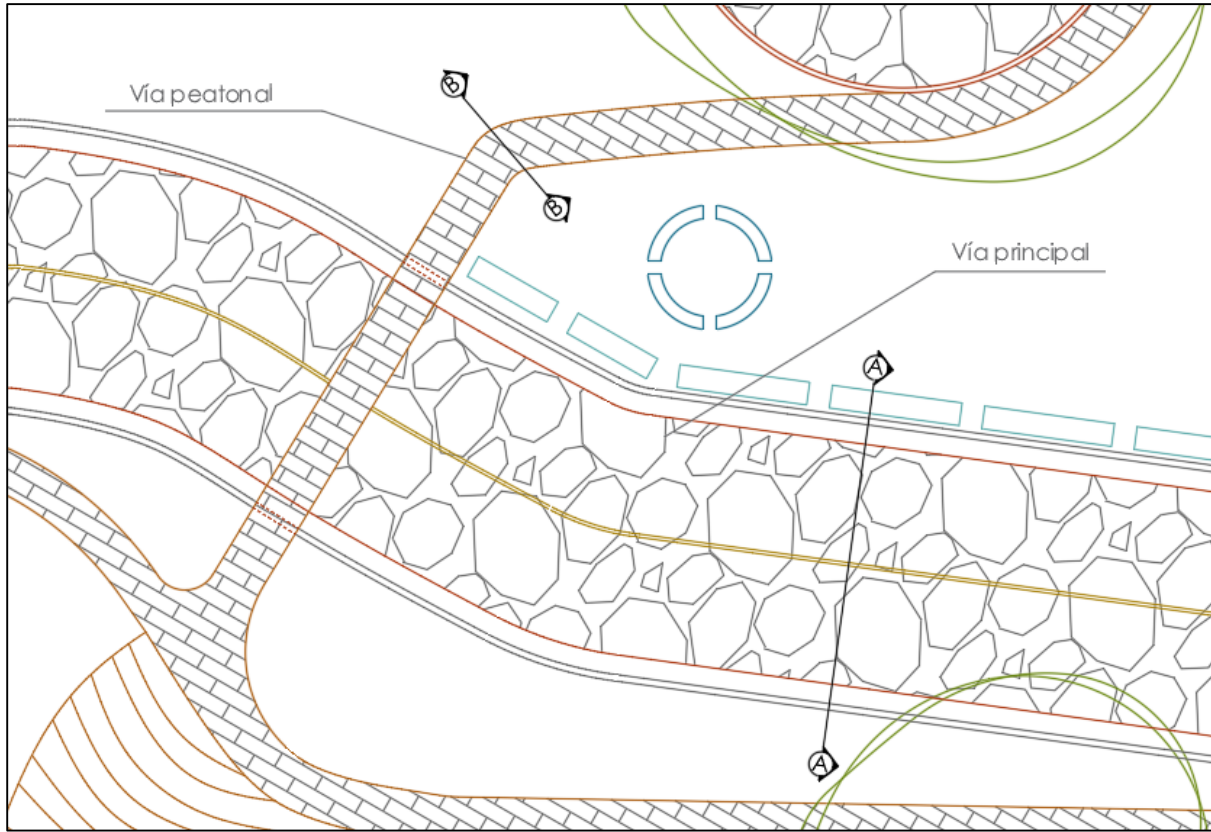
Plano ubicación de cortes para vista de sección de pavimentos. Elaboración propia, 2022.
